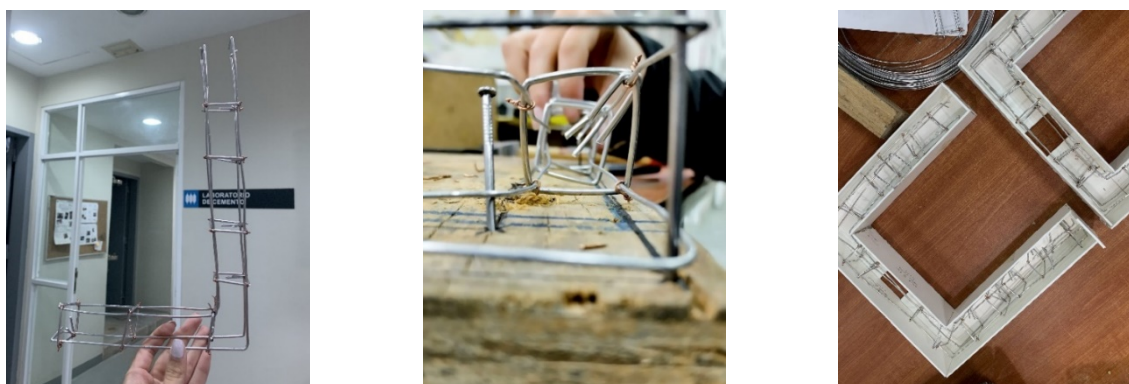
Armado de aceros de refuerzo de las piezas que conforman la estructura tenséfrica.
